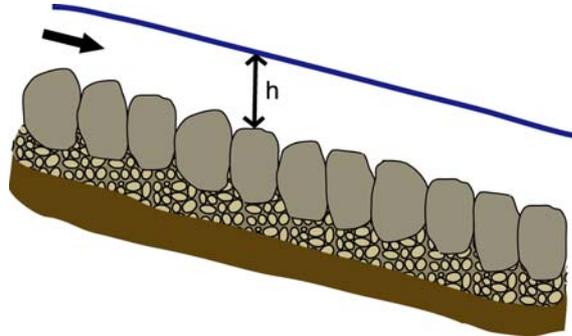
Coupe transversale schématique d'une rampe en enrochements jointifs.
